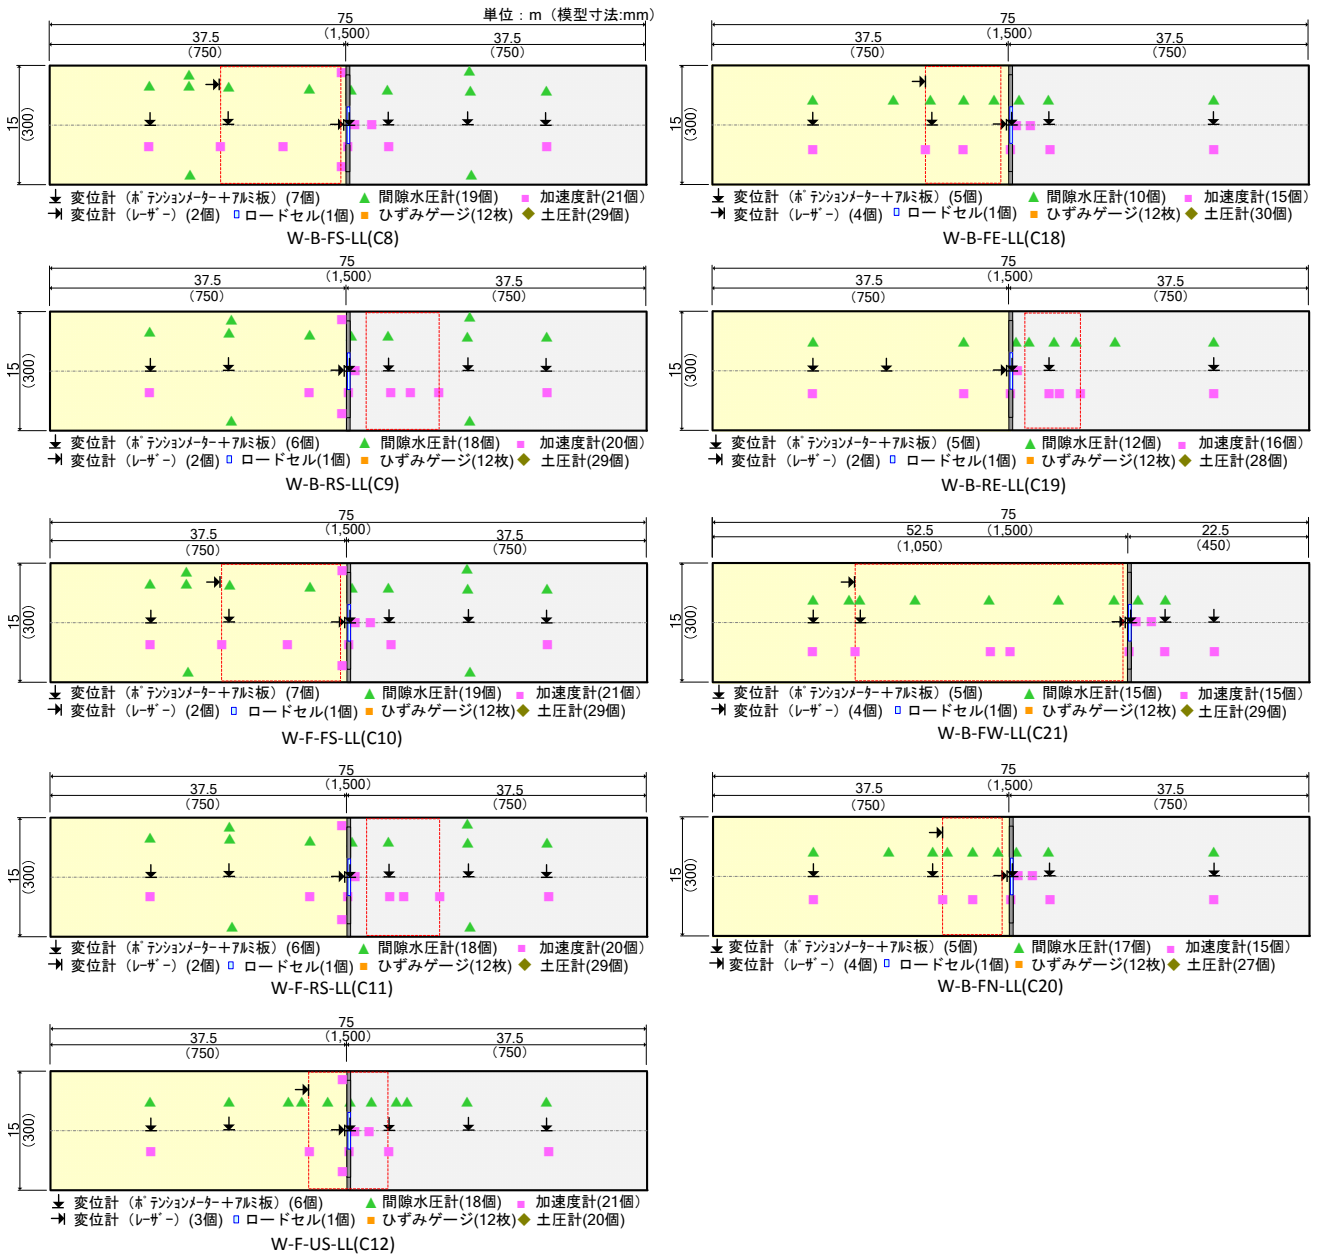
(1)-b 模型平面図 (擁壁の改良体有り (2層))
